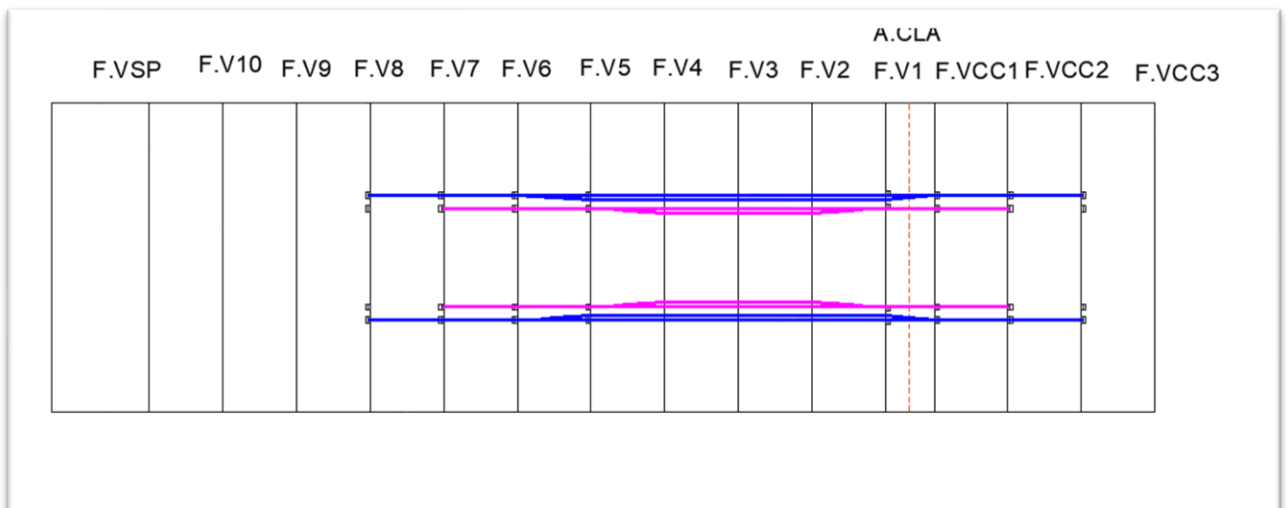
Schéma se trace en plan de câbles de continuités de travée de rive droite
